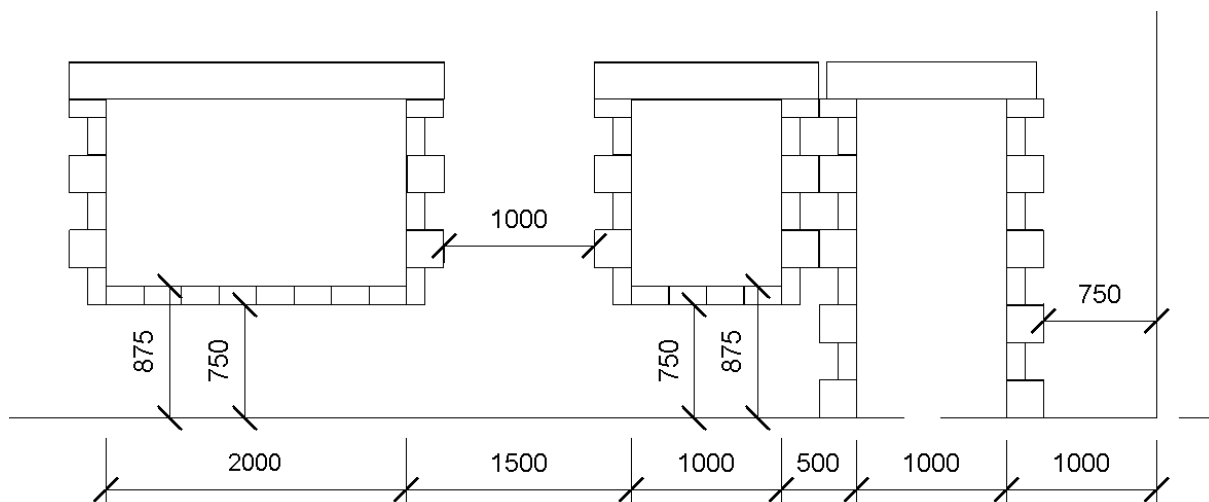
Stropní konstrukce bez ořezání geometrie
